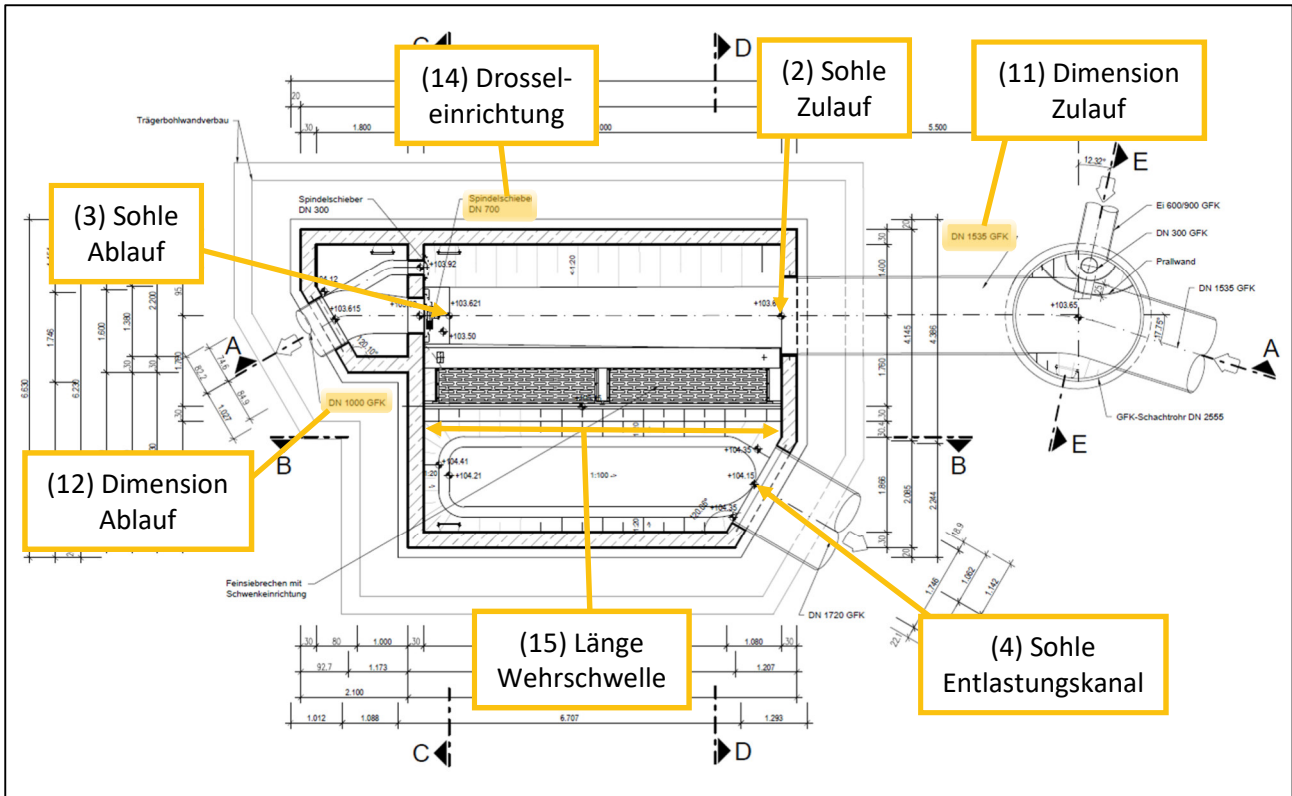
Beispiel Mischwasserentlastungsbauwerk Grundriss
